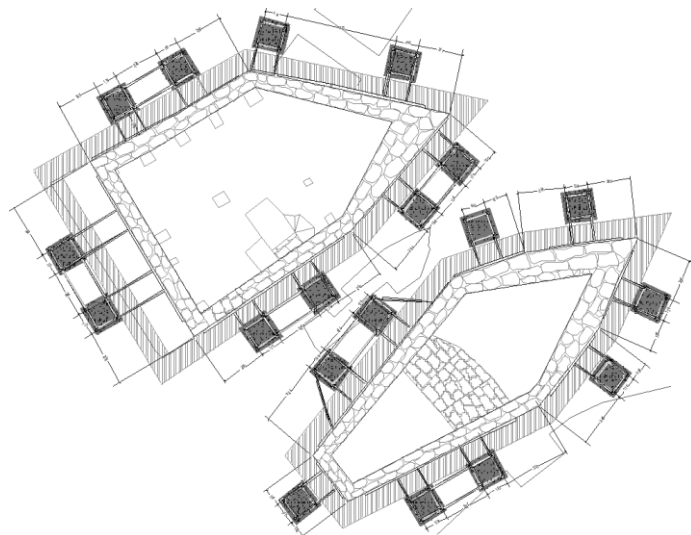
Replanteo de los estabilizadores a tener en cuenta antes de los trabajos de excavación y cimentación.
